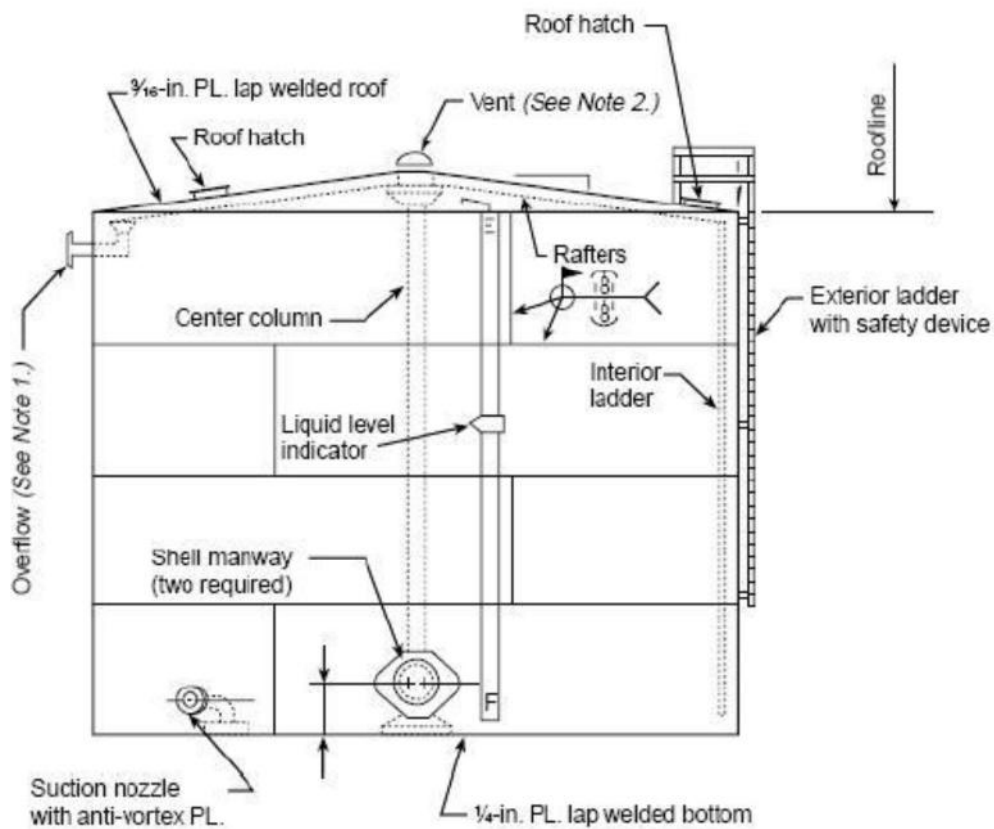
Depósito tipo Chapa acero.
